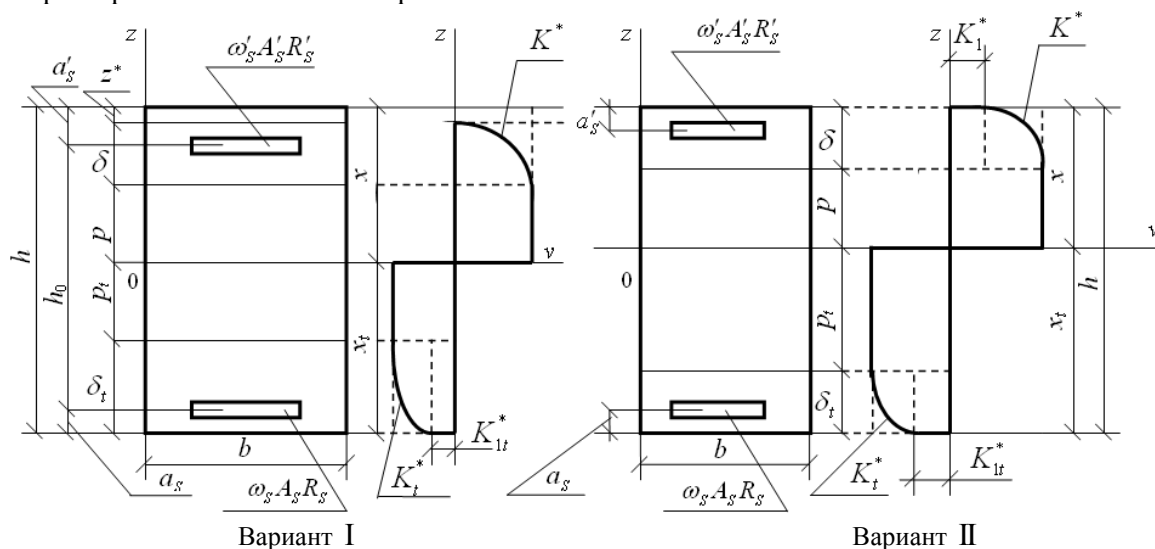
Поперечное сечение железобетонного элемента (вариант I, вариант II)
